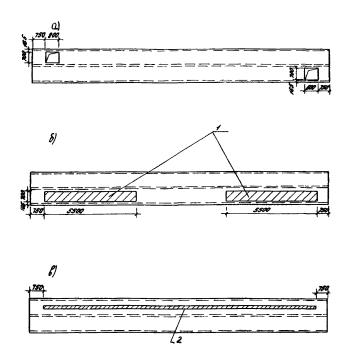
Схема возможного размещения отверстий в нижней полке коробчатого настила
